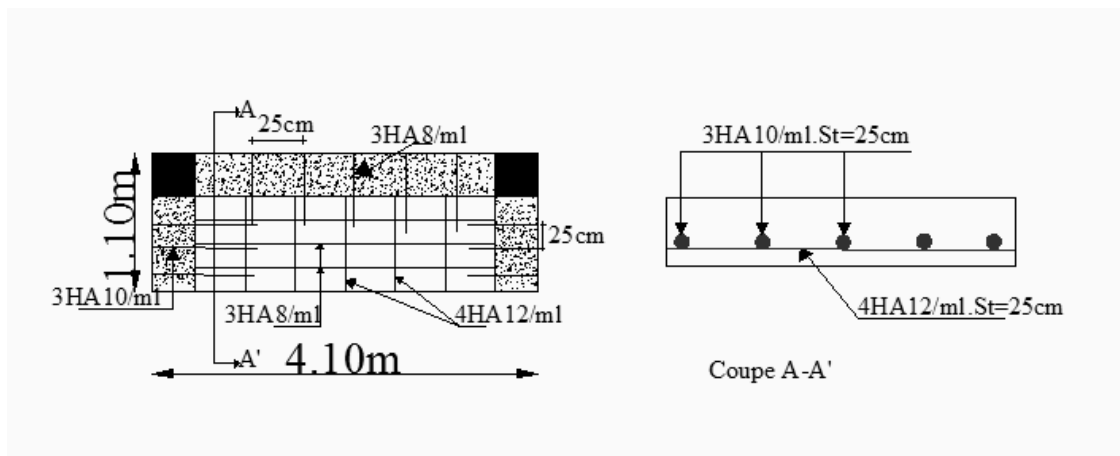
Schéma de ferrailage de dalle sur 3 appuis.
